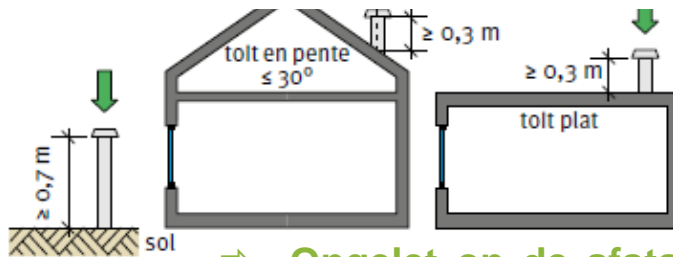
Hauteur minimale des prises d'air placées au sol (à gauche) et sur une toiture dont la pente n'est pas supérieure à 30° (à droite).
